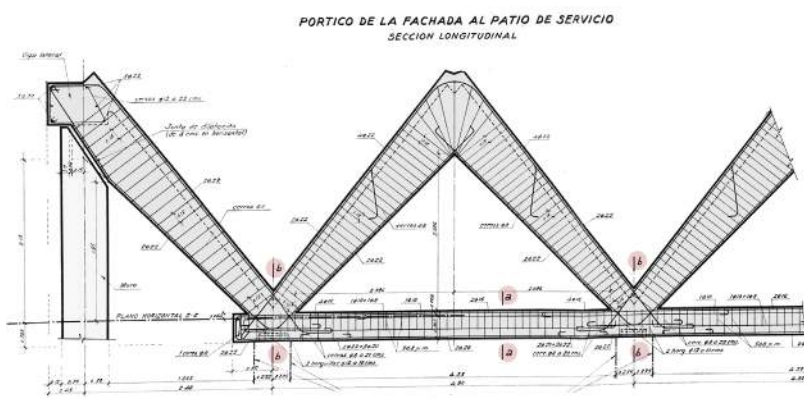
SECCIÓN LONGITUDINAL - FACHADA AL PATIO DE OFICIO
